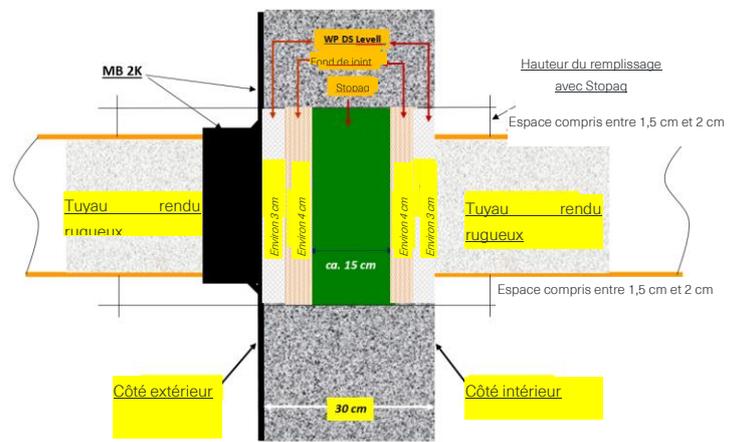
détail de l'étanchéité à l'eau de la traversée de tuyau - étanchéité autour du tuyau
